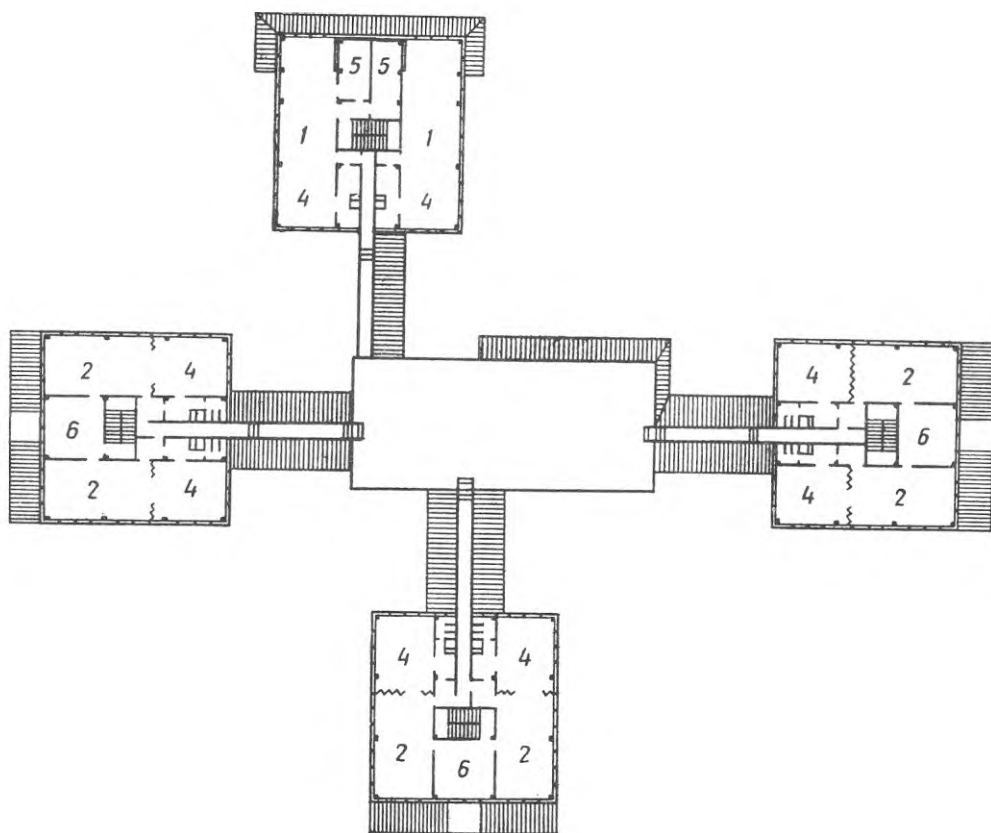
37 Internat för 380 barn. Plan av övervåning. Observera det öppna sambandet mellan grupprum och sovrum. Centralkroppen är i en våning och innehåller kök, tvättstuga, rum för musiklektioner och lek samt isoleringsrum.
